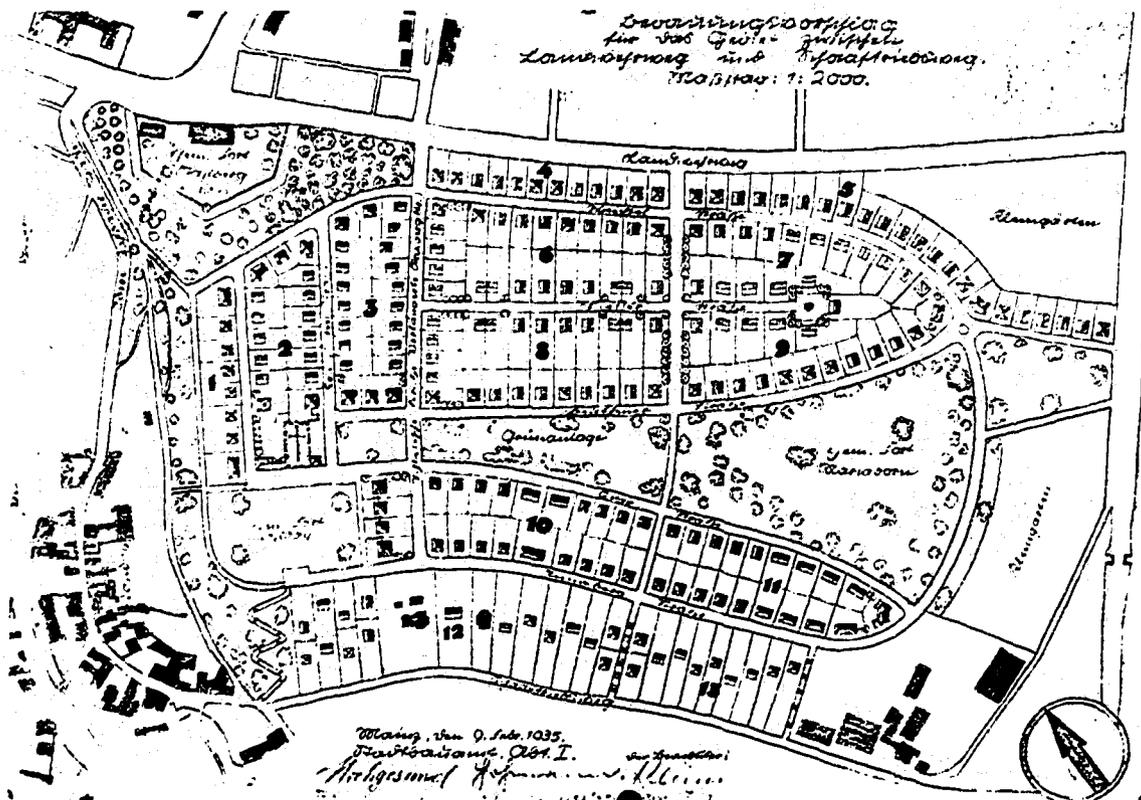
Entwurf: Stadtbaurat Hochgesand, Stadtbaumeister Hohmann, Mainz
